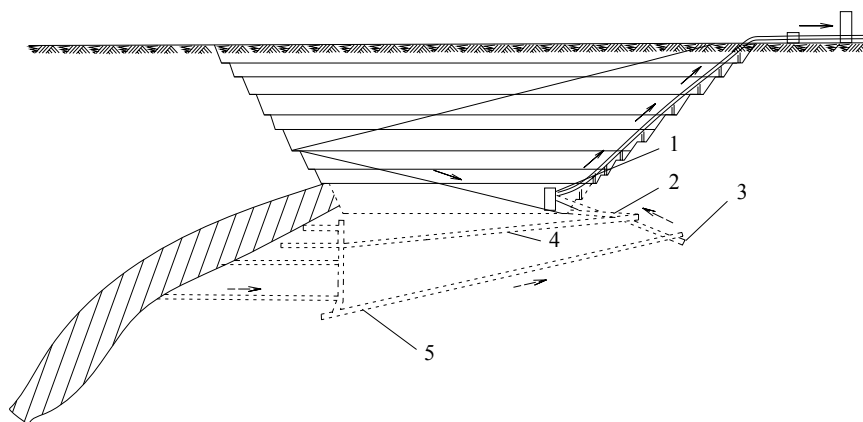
Технологическая схема с размещением КНК в открытых и подземных горных выработках: 1 – перегрузочный бункер; 2 – портал наклонного съезда; 3 – перегрузочная станция; 4 – наклонный съезд; 5 – конвейер
